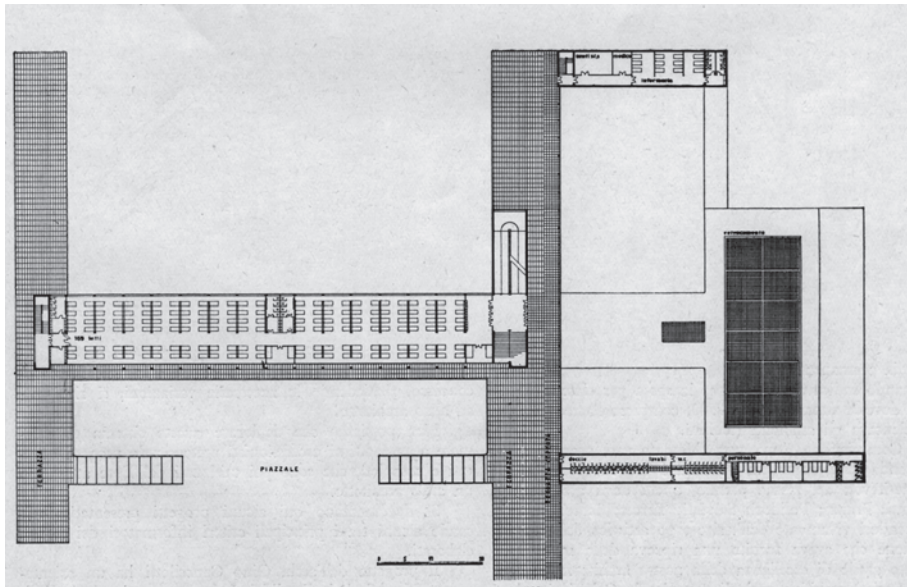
Montecatini-Wettbewerbsentwurf (E.Montuori): Grundriss 1.OG
